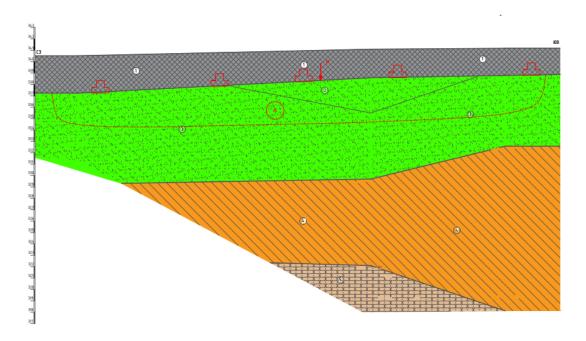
Расчетная схема основания столбчатого фундамента
